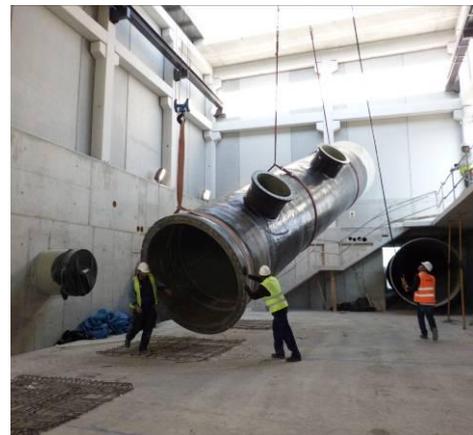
Distintas fases en la construcción de los edificios de la planta desaladora de Torrevieja.
